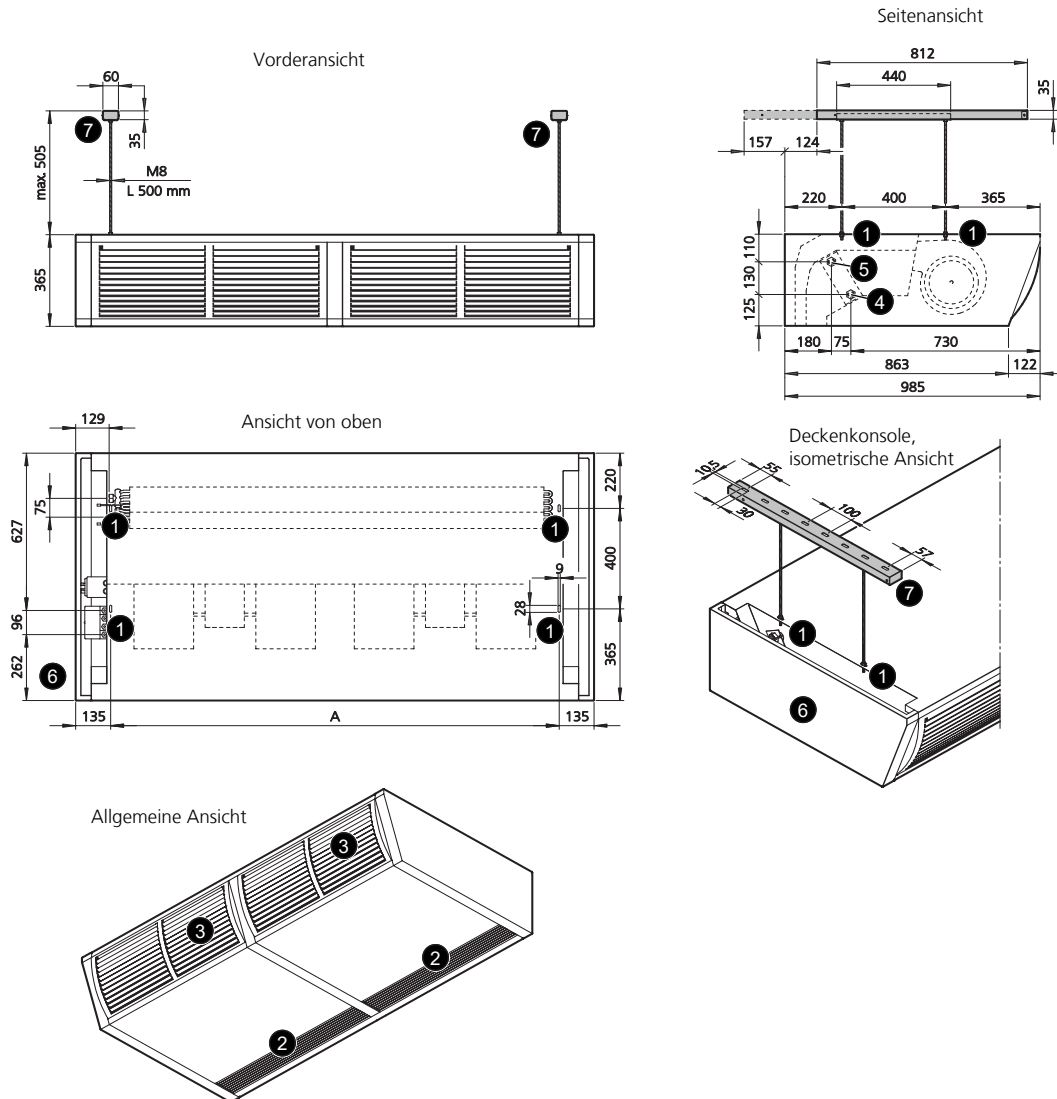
Aufhängepunkte Tandem 365 BG 12- 27 mit Deckenkonsolen
